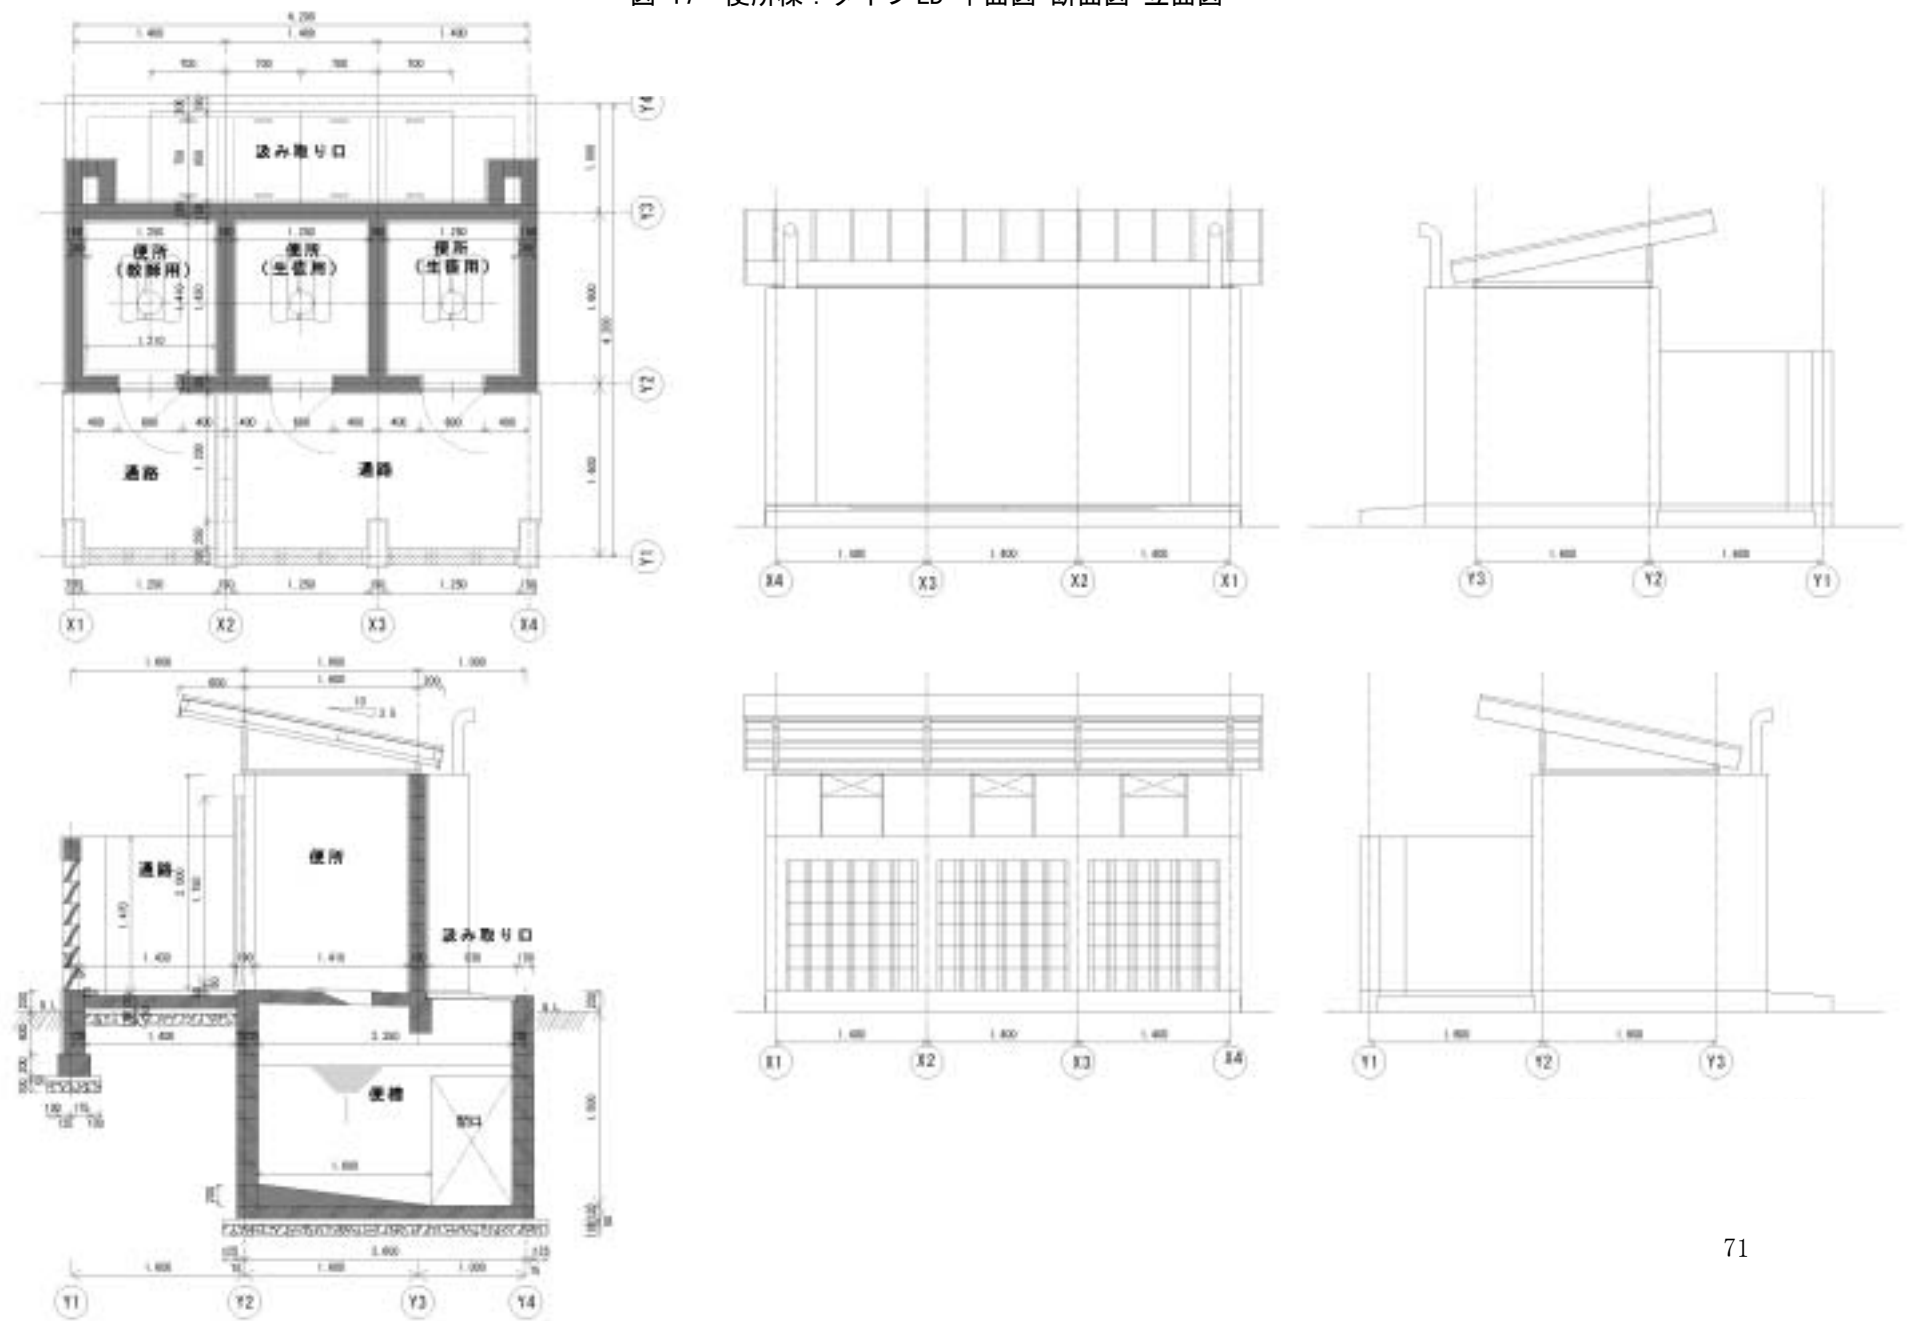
便所棟：タイプ LA 平面図・断面図・立面図
